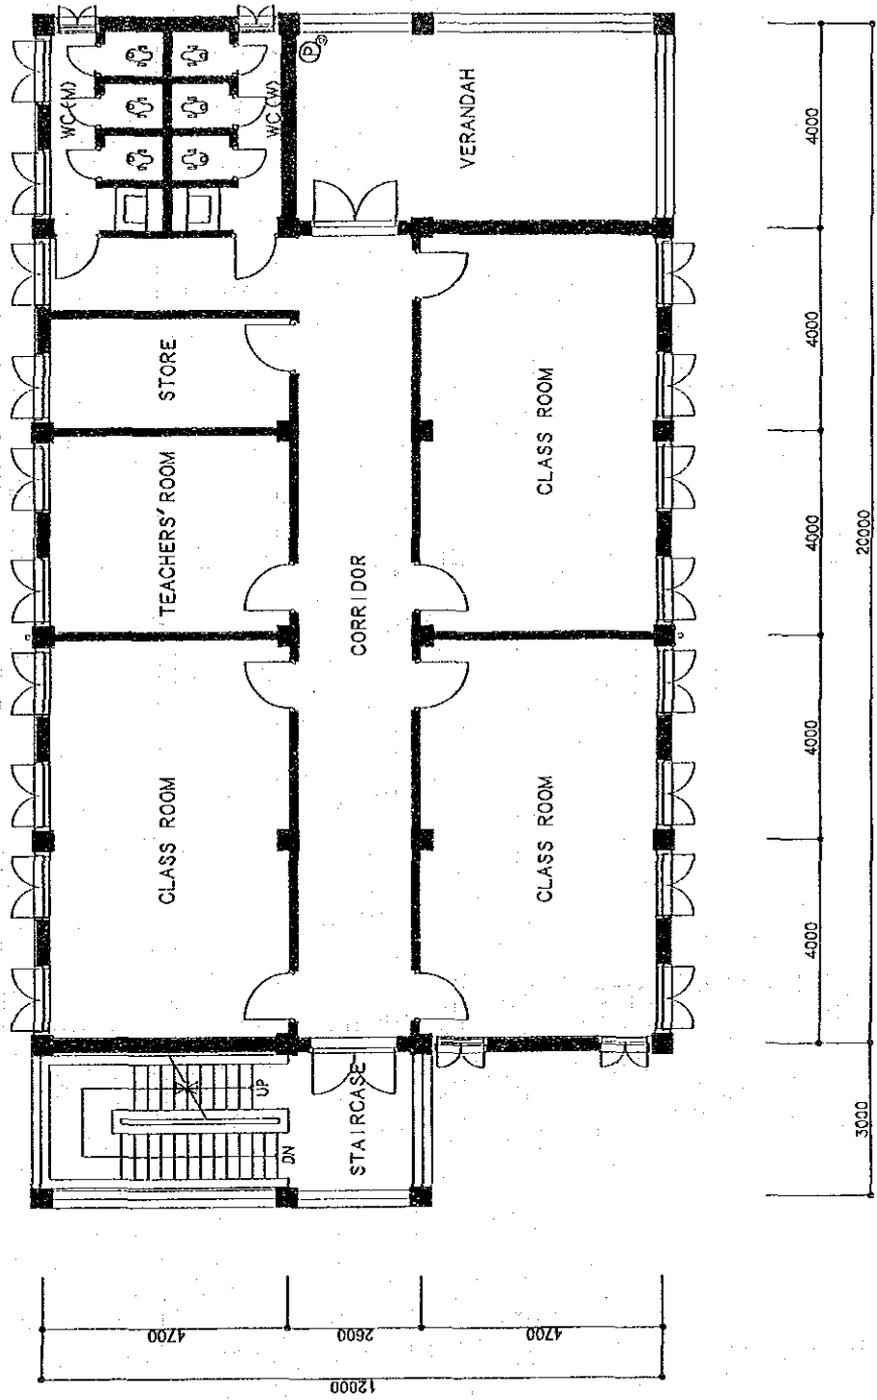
(2) 2階平面図 (3教室タイプ)
